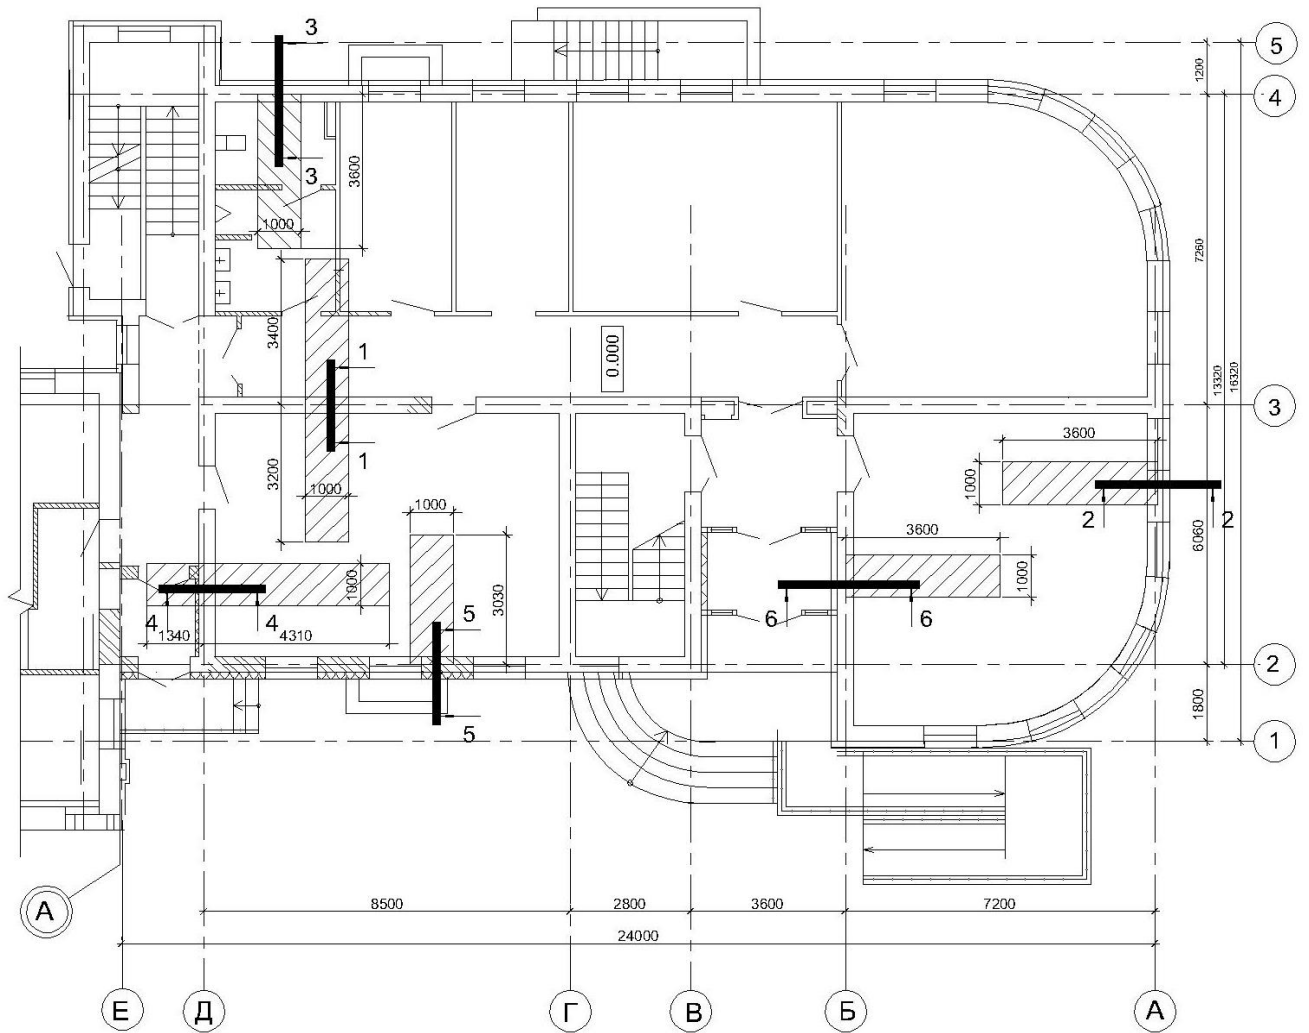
Схема расположения нагрузок и определение грузовых площадей
